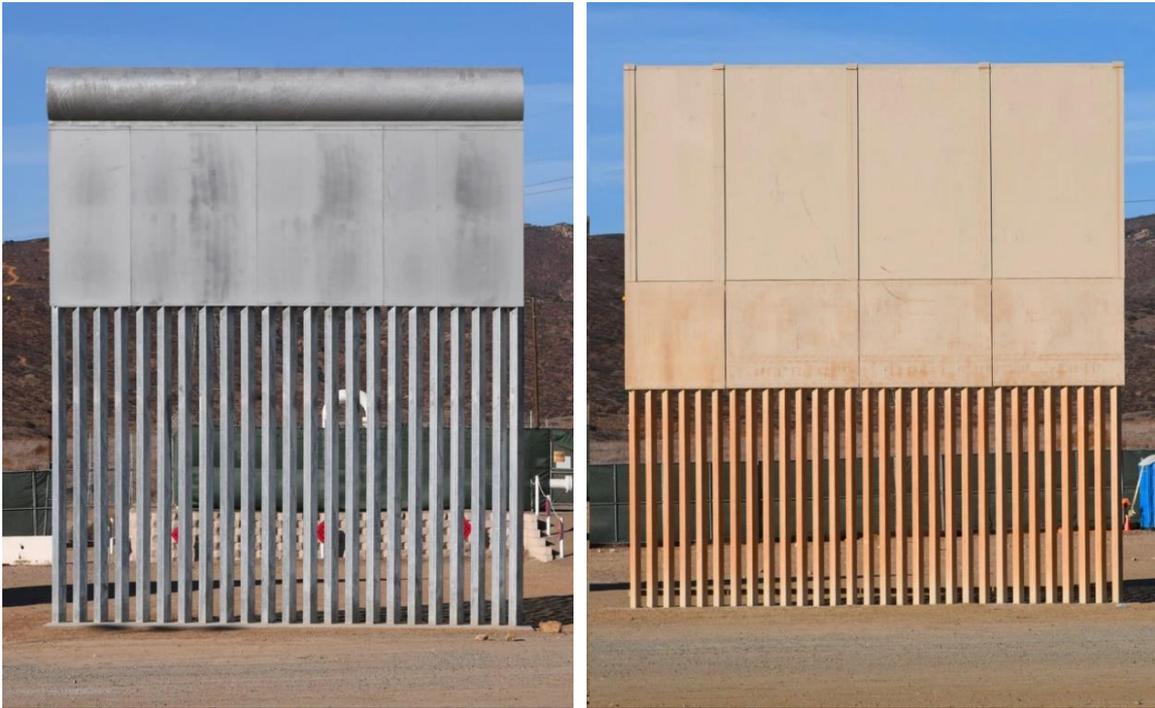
Gli otto prototipi di muro (Foto di Guillermo Arias, cortesia dell'autore)
